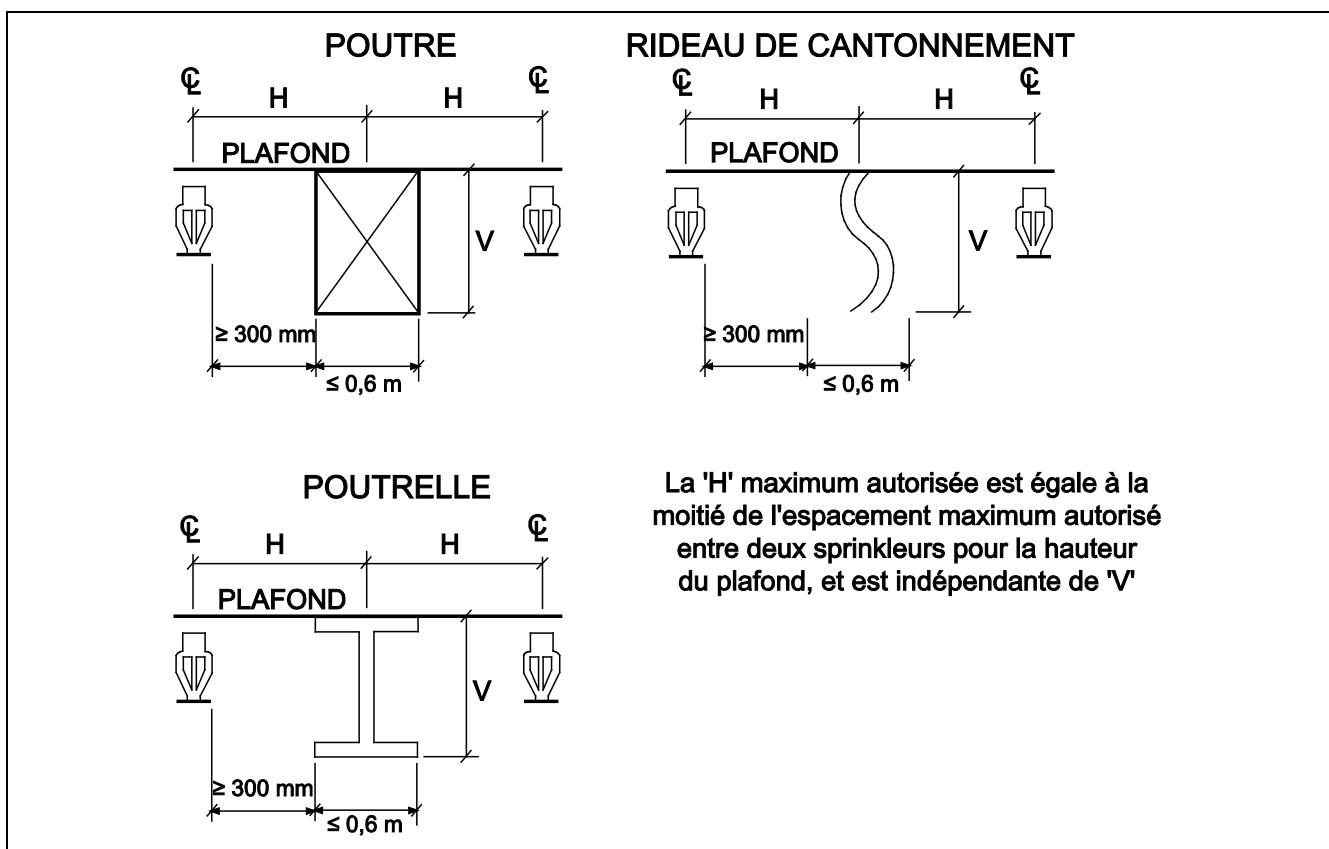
Installation de sprinkleurs supplémentaires pour palier l'obstruction au profil de distribution par des objets pleins en toiture.
